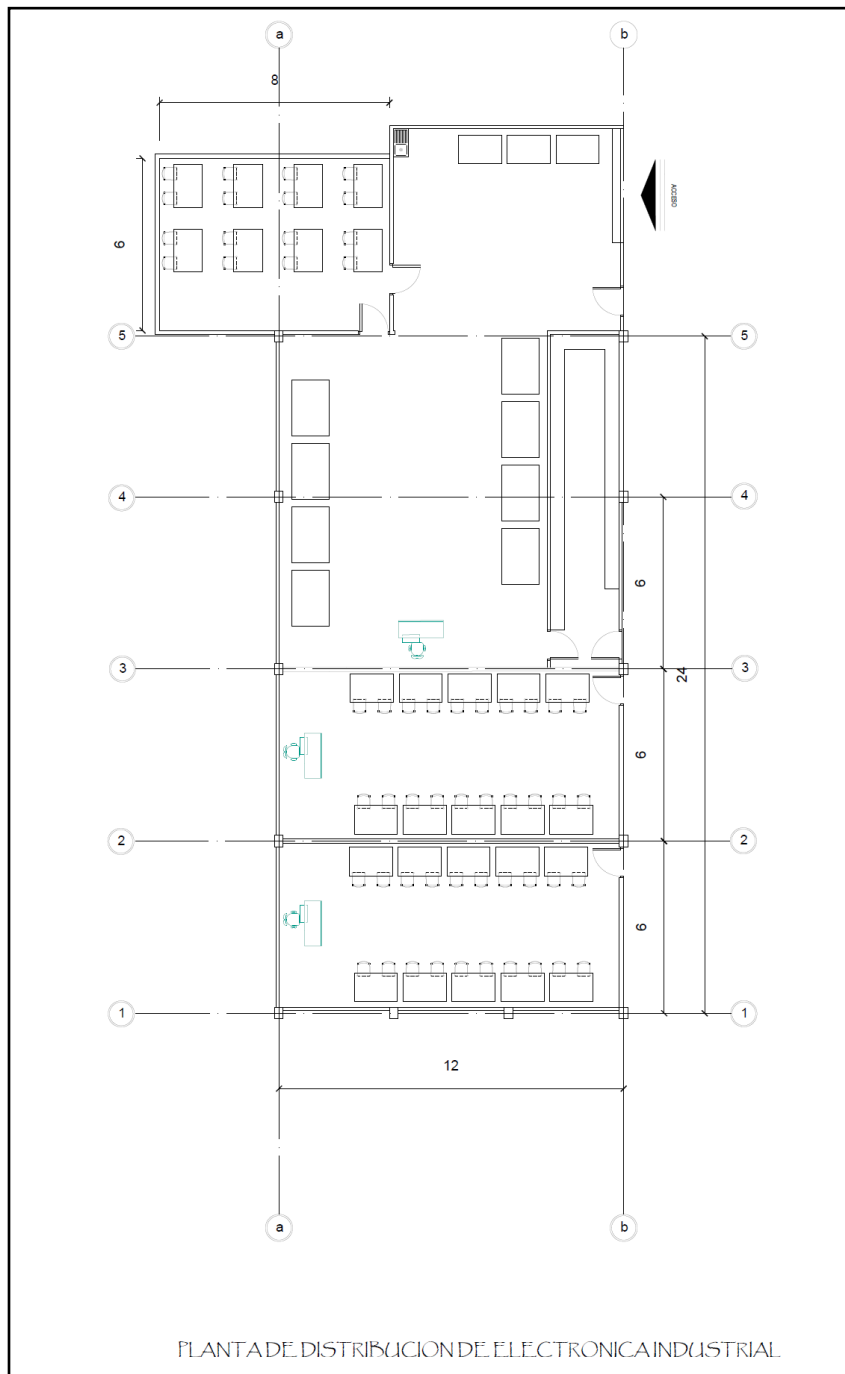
Plano Levantamiento planta física del taller de Electrónica Industrial
